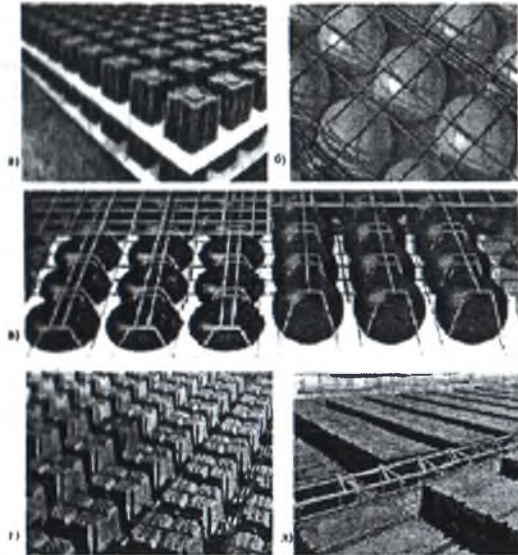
Системы с применением полимерных вкладышей: а) Airdeck, б) BubbleDeck, в) Cobiax, г) U-Boot Beton, д) U-Bahn Beton
